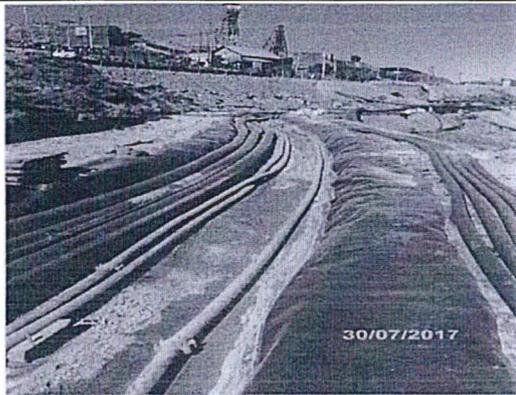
En las Coordenadas E 0344476 y N 8780572 Estandarización de las tuberías de relleno hidráulico
